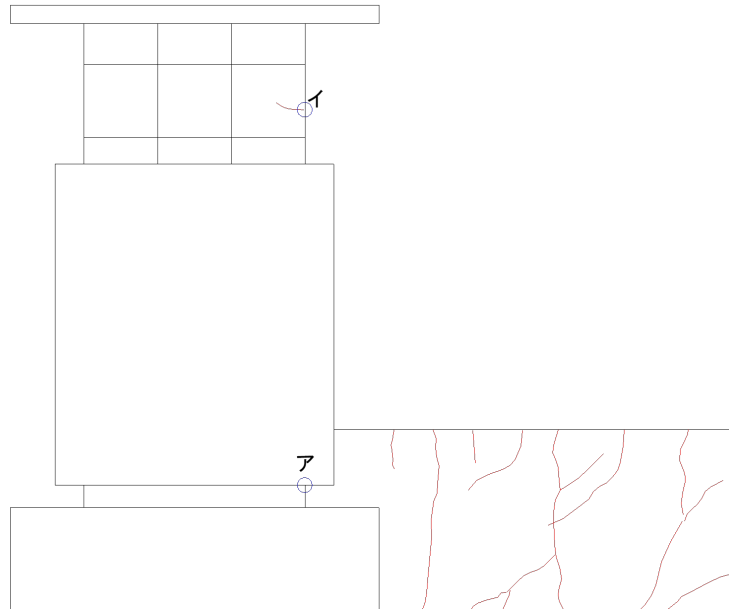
柱ひび割れ幅測定位置(試験体 A-3 負載荷)
